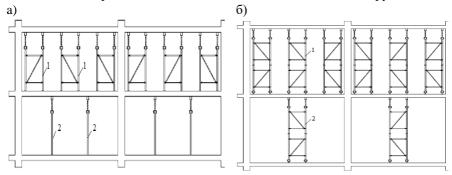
Схема установки страховочных подпорок и подпорок: а — из телескопических стоек; б — из опорных башен; 1 — страховочная подпорка; 2 —подпорка
